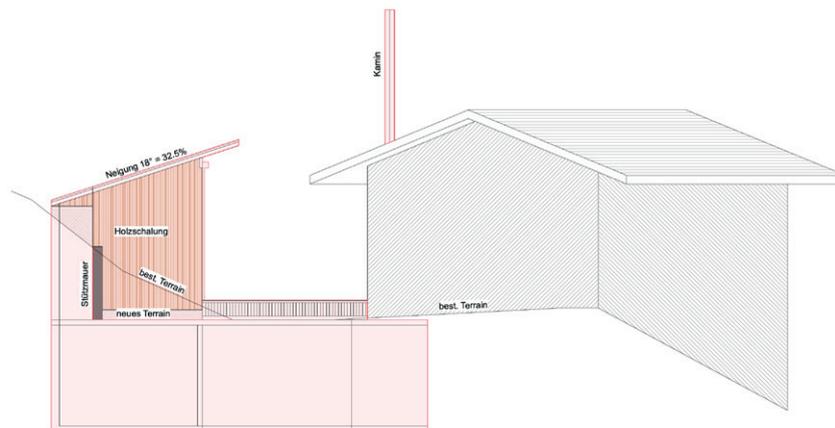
Fassadenansicht Nord; geplante Bauten und Anlagen in rot; Quelle: Allotherm AG
